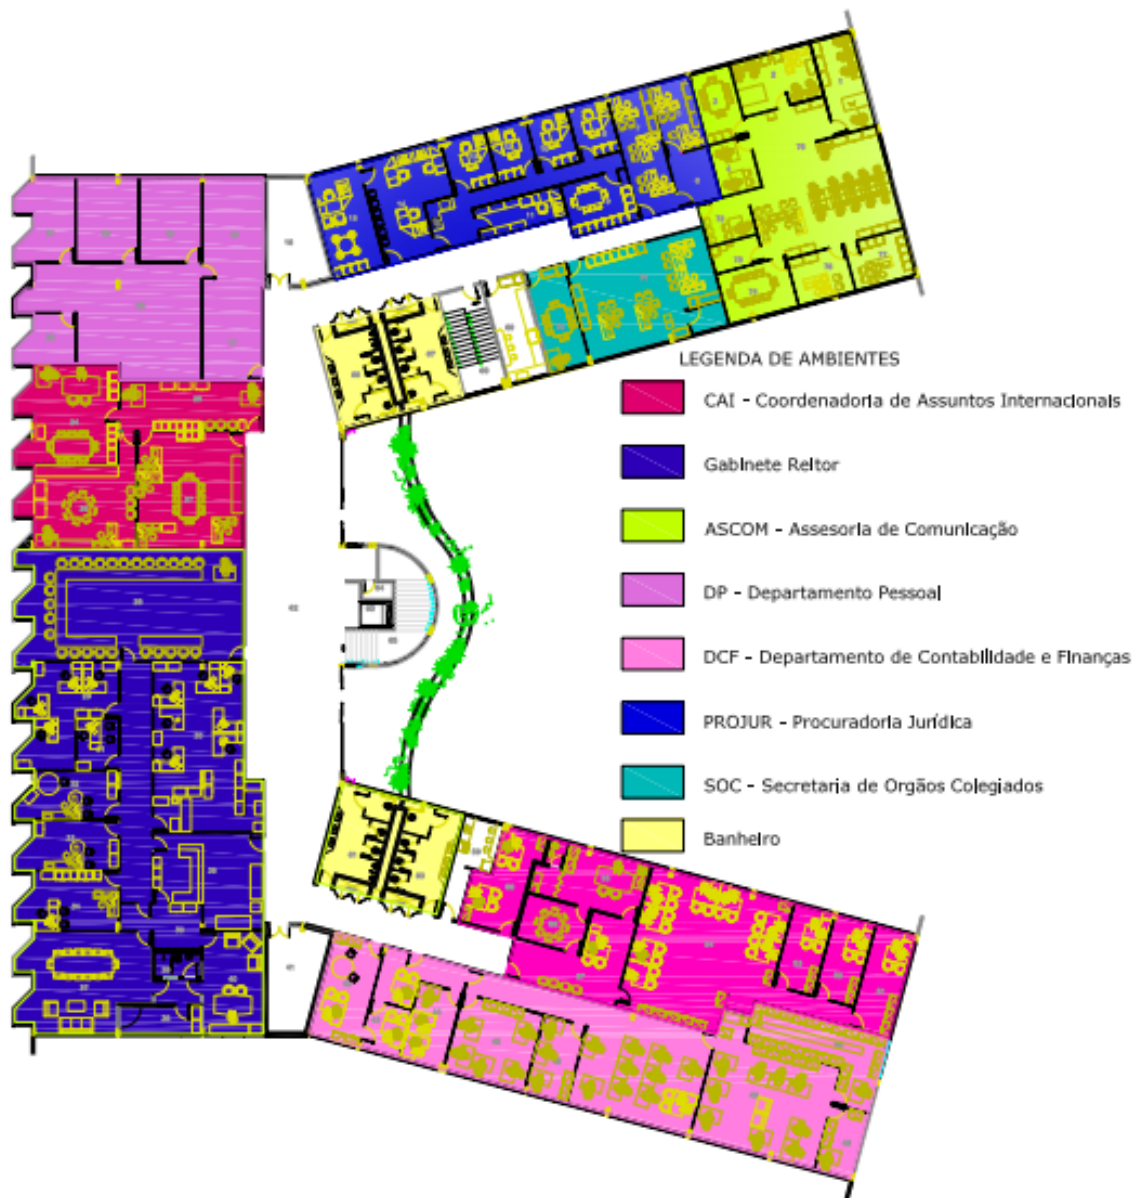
6: Planta baixa da reitoria, pavimento superior com legenda de ocupação.
